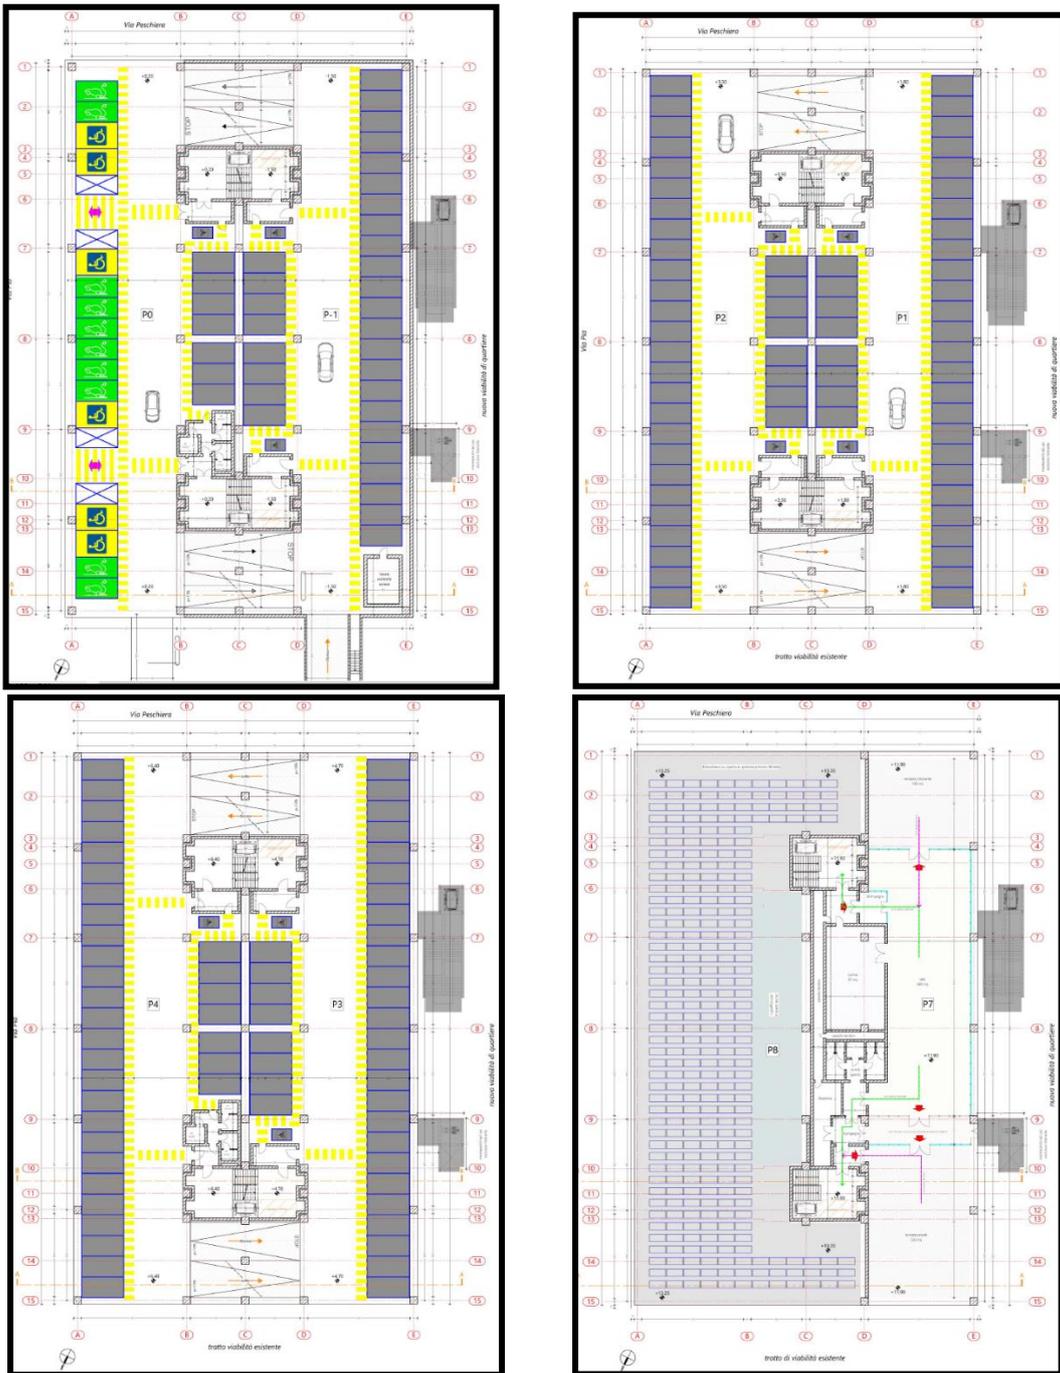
stralcio della planimetria dei diversi piani dello stabile in progetto
